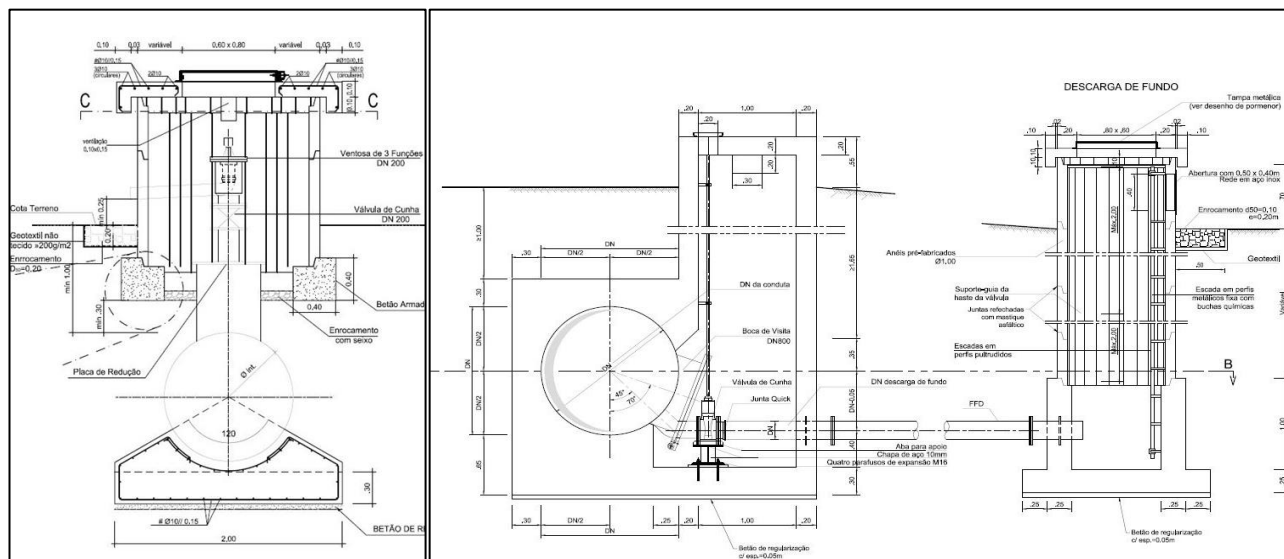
Conduta elevatória. Câmaras da ventosa e da descarga de fundo para condutas com DN ≥ 1200
